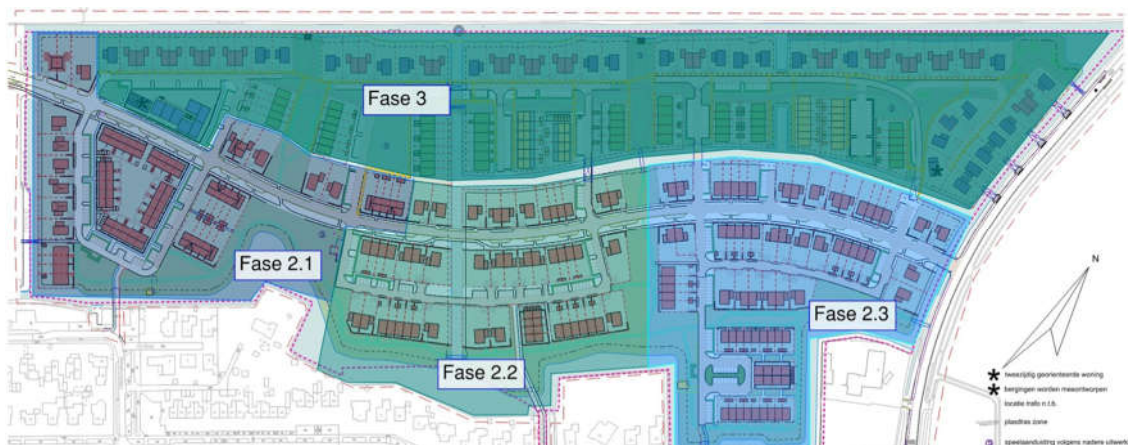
Verbeelding uitwerkingsplan 't Veld Noord fase 2 en 3
